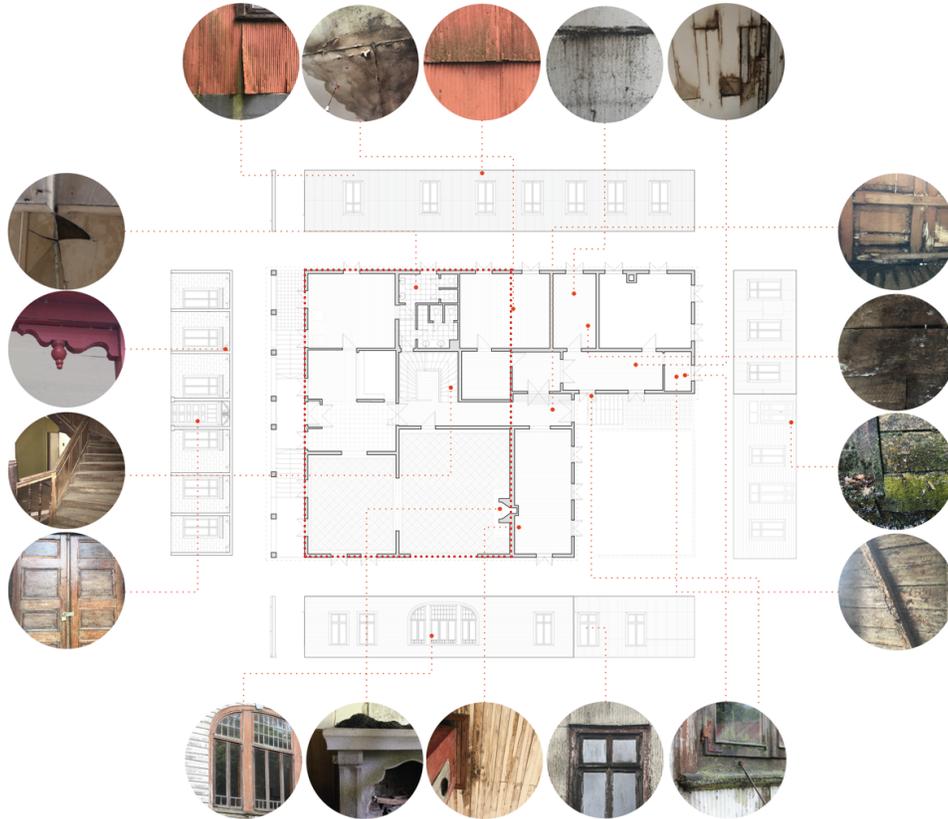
Planta 1º nivel; el rectángulo rojo es el perfil original según Guarda (1980), (fuente: elaboración propia, 2022).
